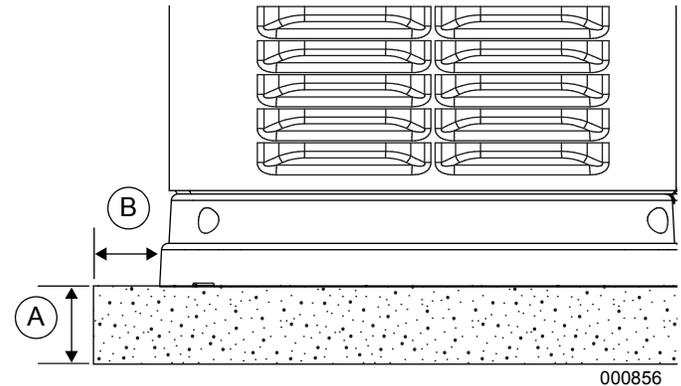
Surface d'appui en gravier ou dalle en béton
